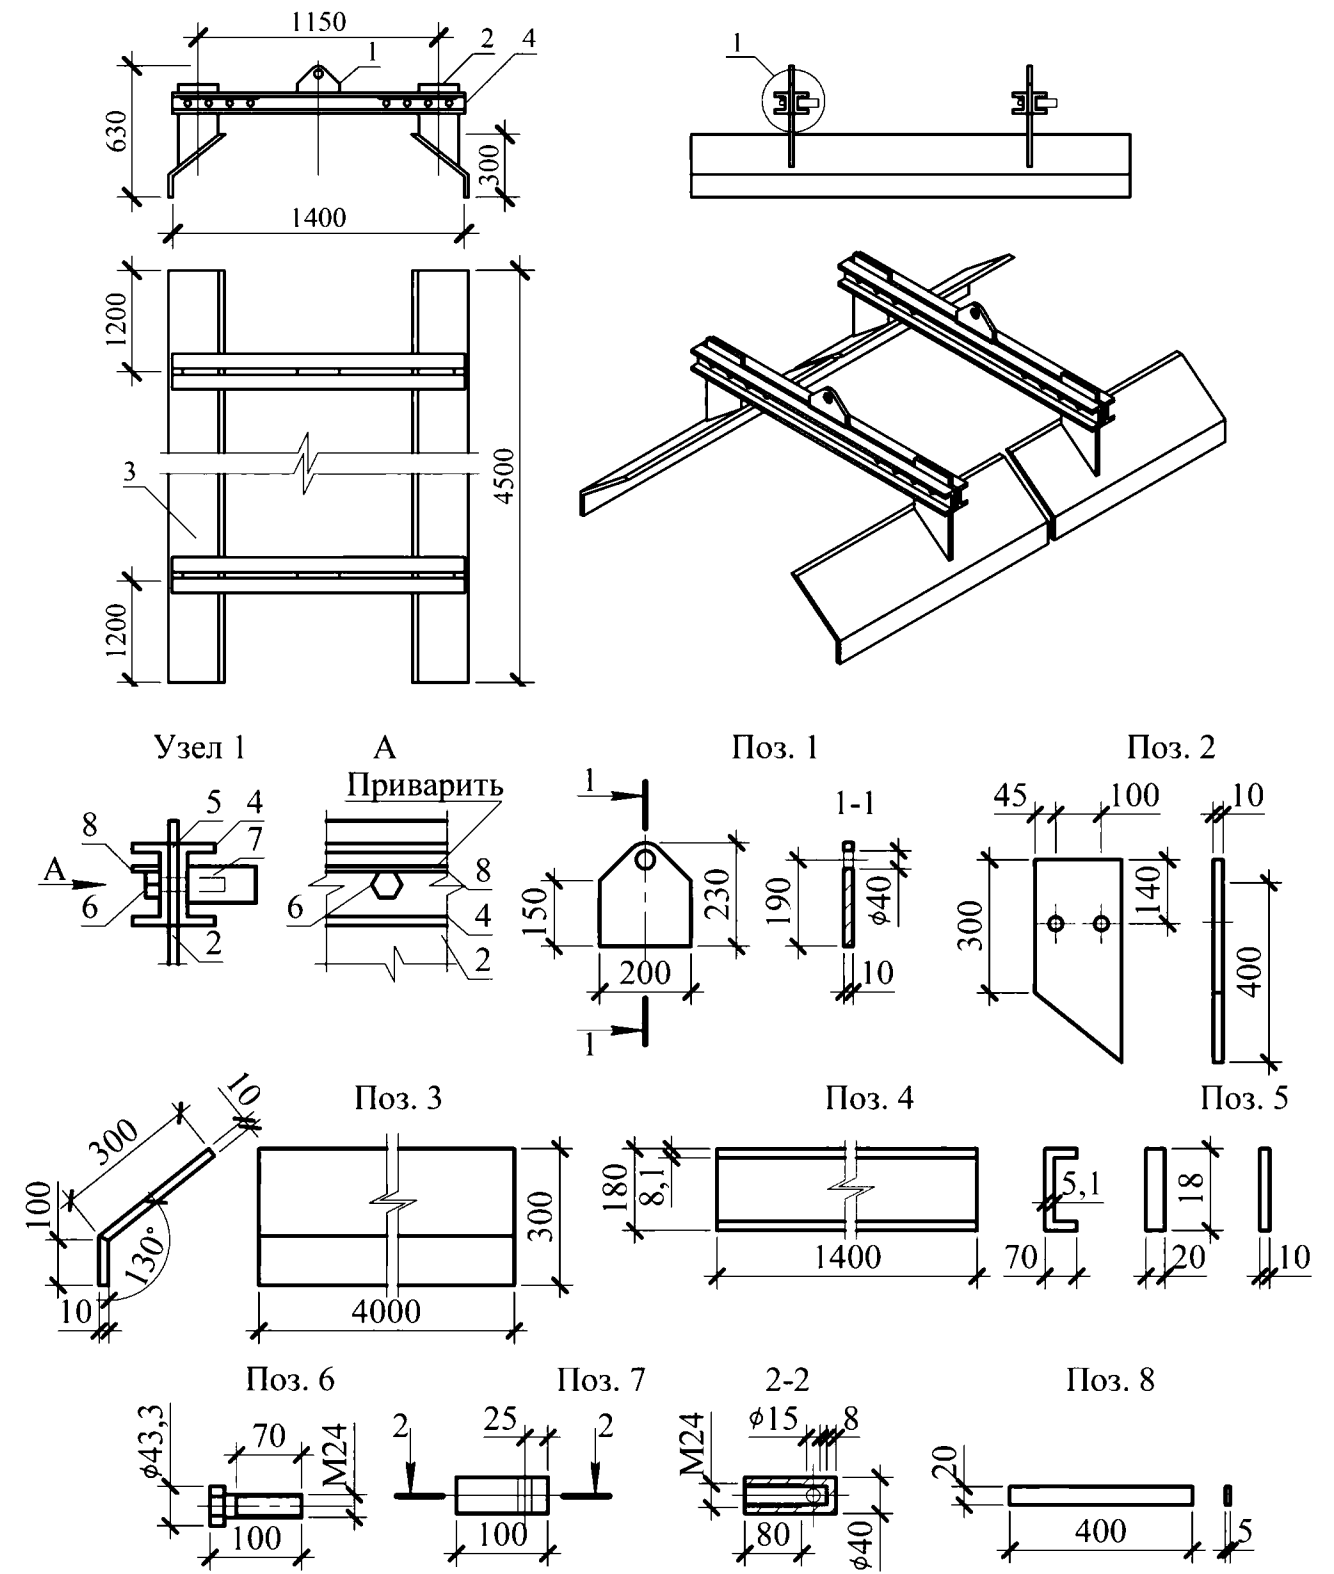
Конструкция блок-формы опалубки для возведения плит монолитных ленточных фундамента
